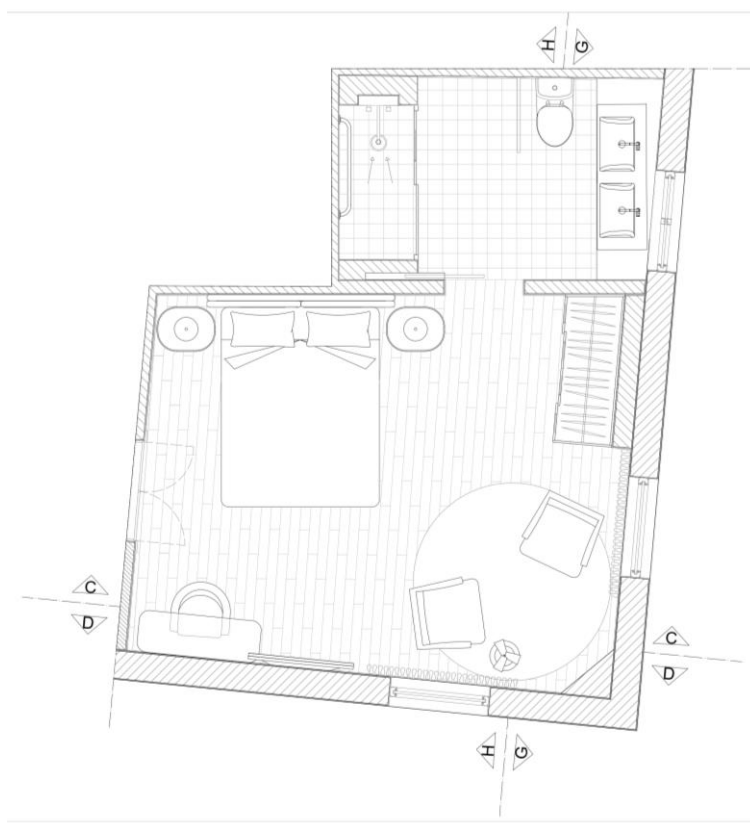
Pormenorização Suíte Moinhos de Água e Instalações Sanitárias. Fonte: Ana Ferreira
